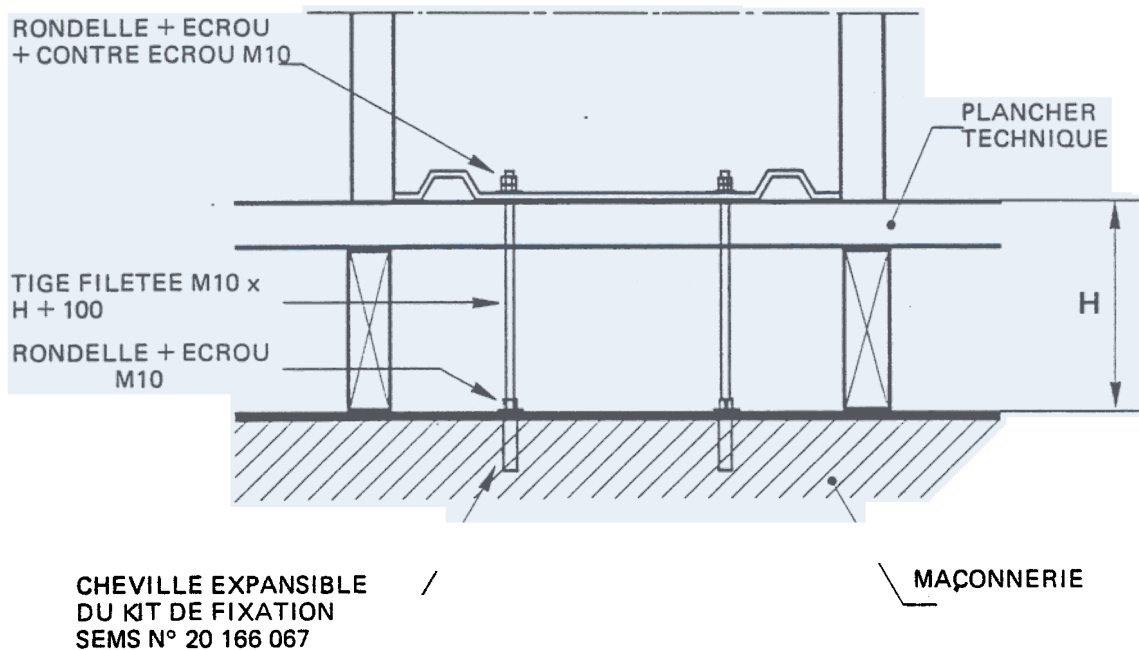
FIXATION SUR PLANCHER TECHNIQUE
